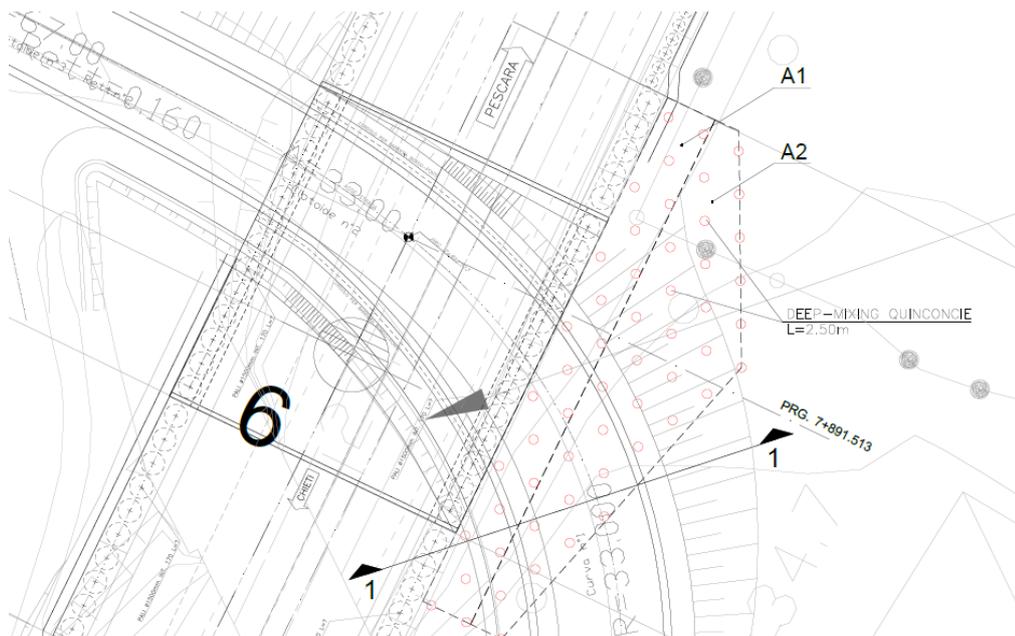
Sezione rappresentativa tratta IV02 - rilevato - planimetria
